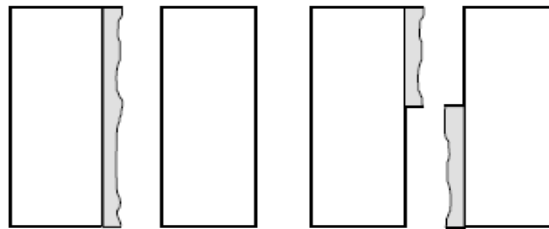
Thyerja e muraturës në mes të llaçit dhe njësisë muratuese
